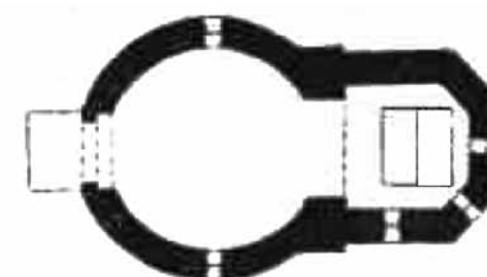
Grundriss Völkermarkt, M 1:200. Kunst-Topographie 1889, 397.
